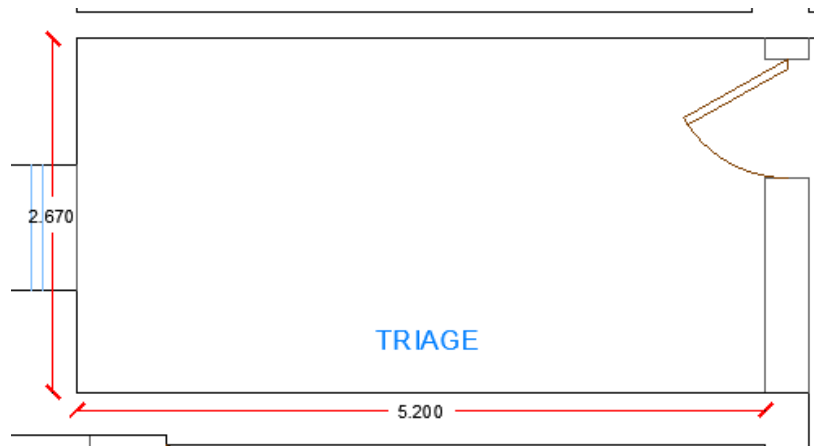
Dimensiones del área de Triage planta baja. [Autor]
